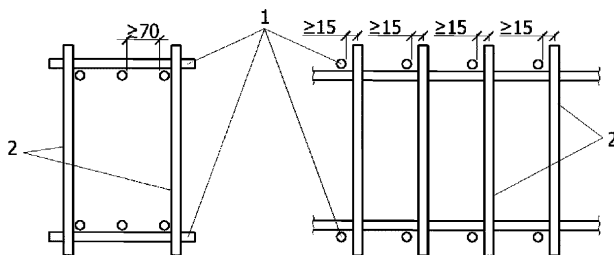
Примеры конструкций пространственных сварных каркасов колонн
